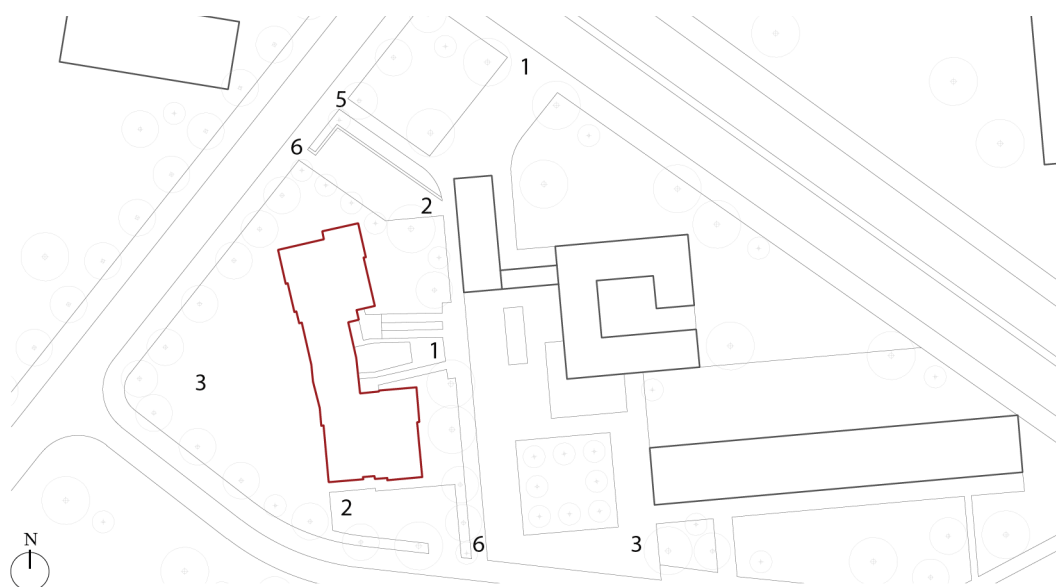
Planta de Conjunto, Hansaviertel. Escala 1:1500.
